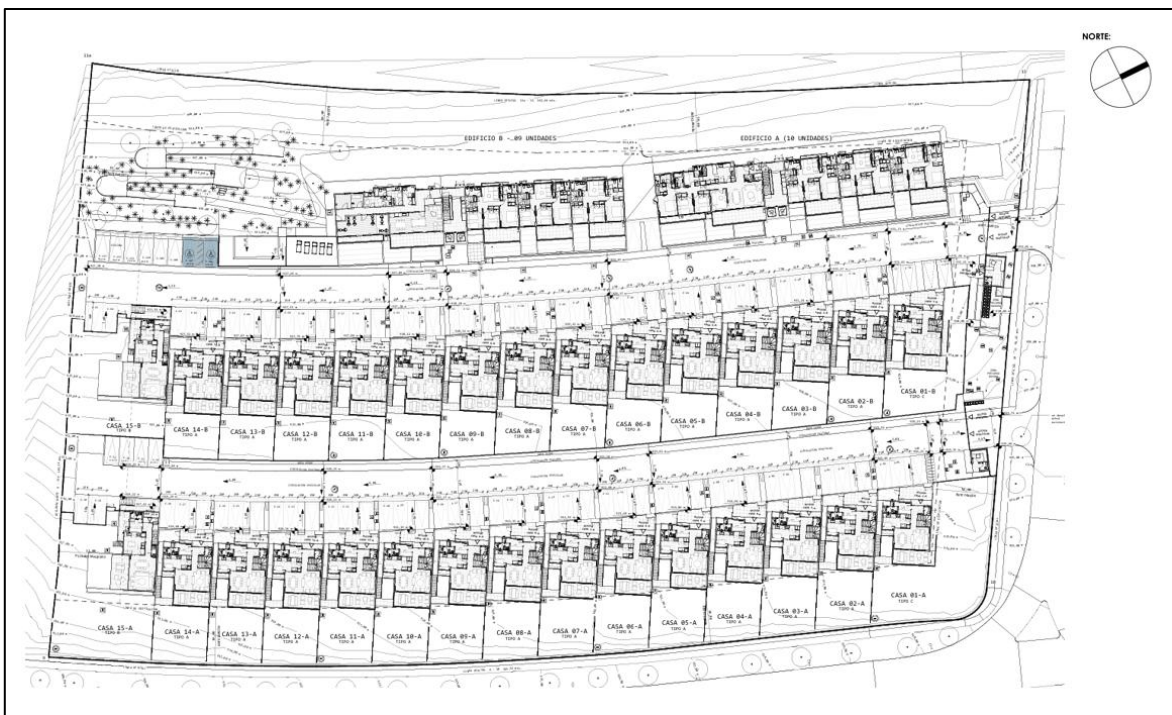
PLANO EMPLAZAMIENTO, PROYECTO "CONDOMINIO SAN CARLOS DE APOQUINDO"
